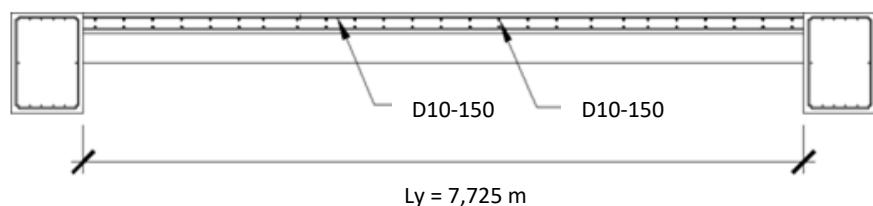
Detail Penampang Tulangan Lapangan Arah Y Plat Type A1
